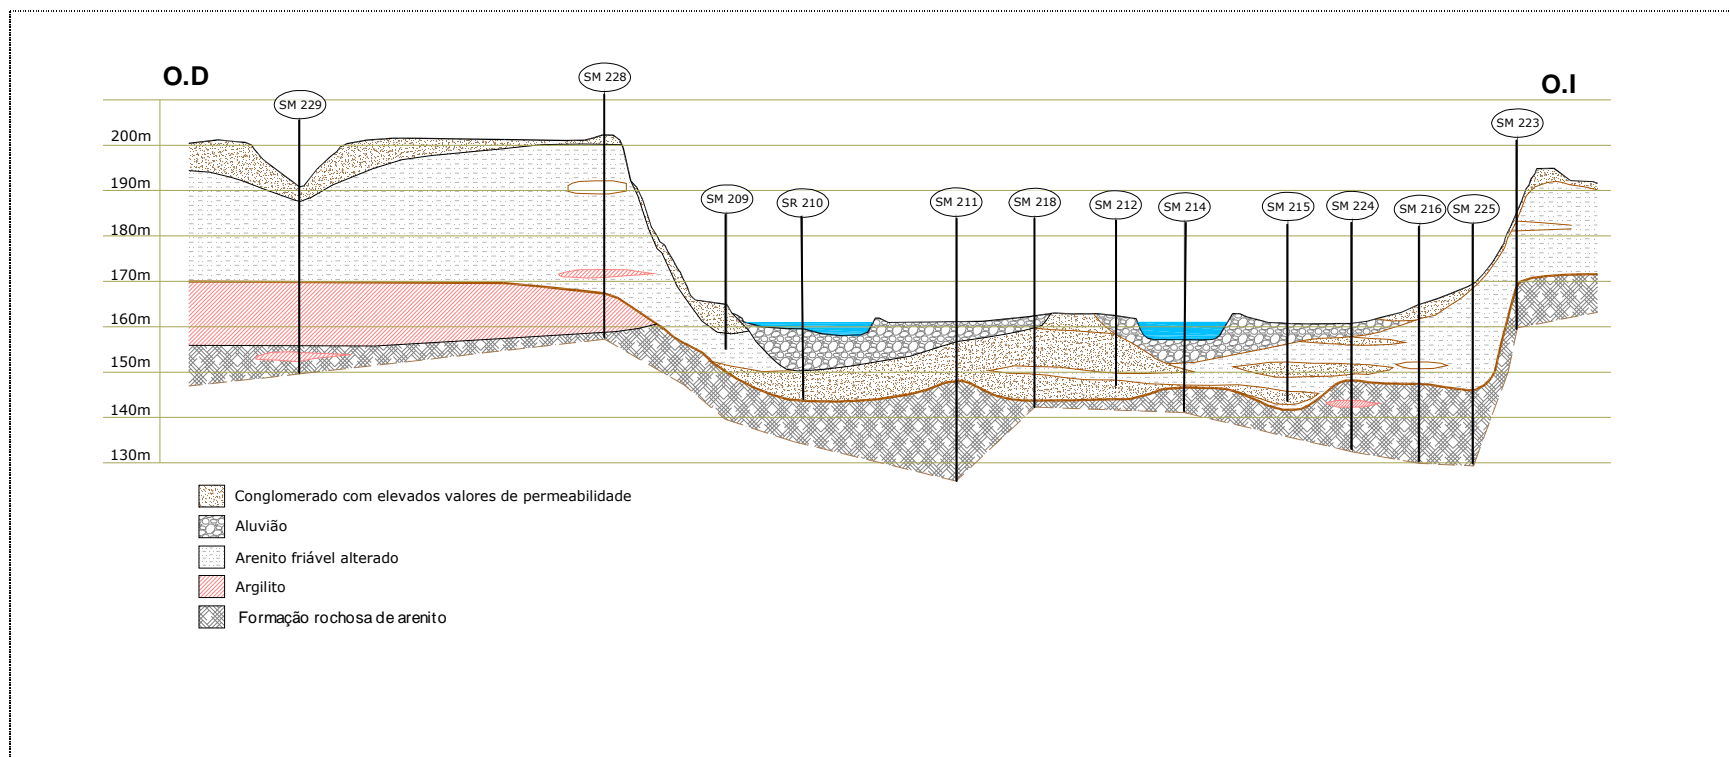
Perfil geotécnico no Eixo da Barragem
